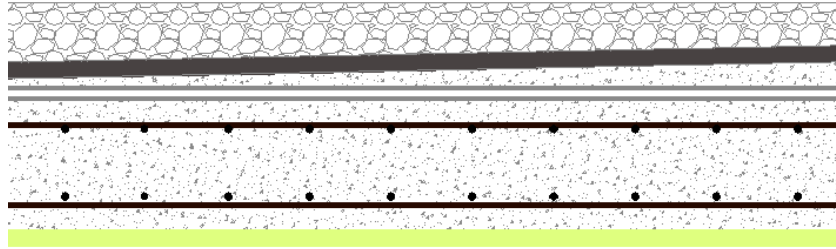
Composants d'un plancher terrasse en dalle pleine
